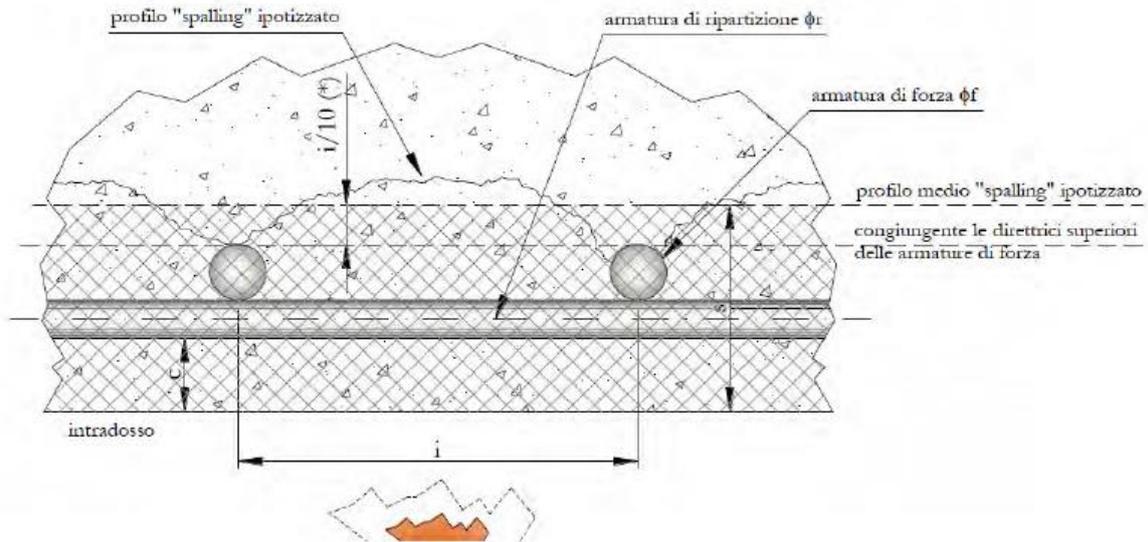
Schema per la valutazione della profondità di 'spalling' per sezioni armate
